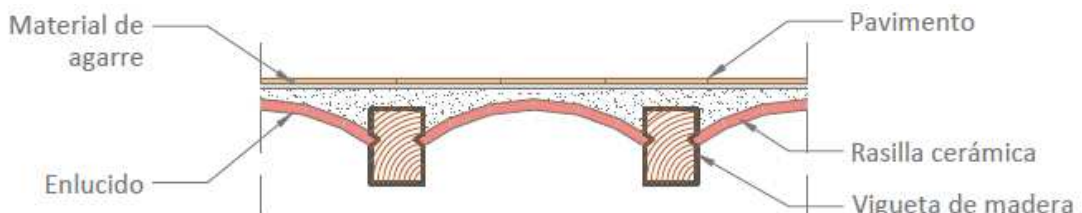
Forjado formado por viguetas de madera y revoltón de rasilla cerámica. Elaboración propia
